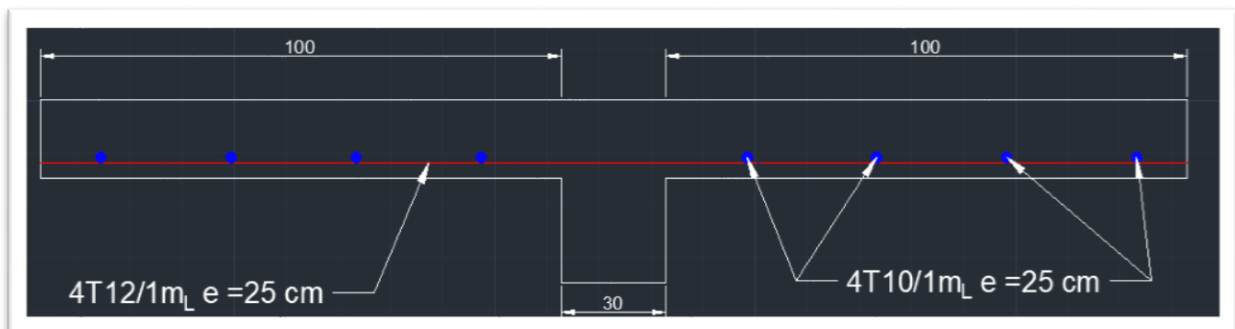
Ferrailage de la dalle pleine du RDC (// à L_x)
